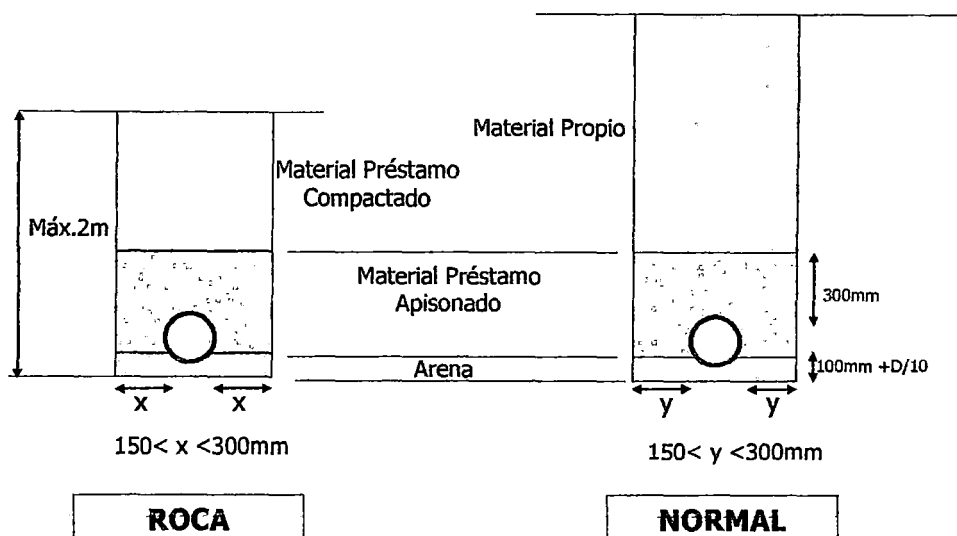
Detalle típico de zanjas de tubería para rebose de la obra
